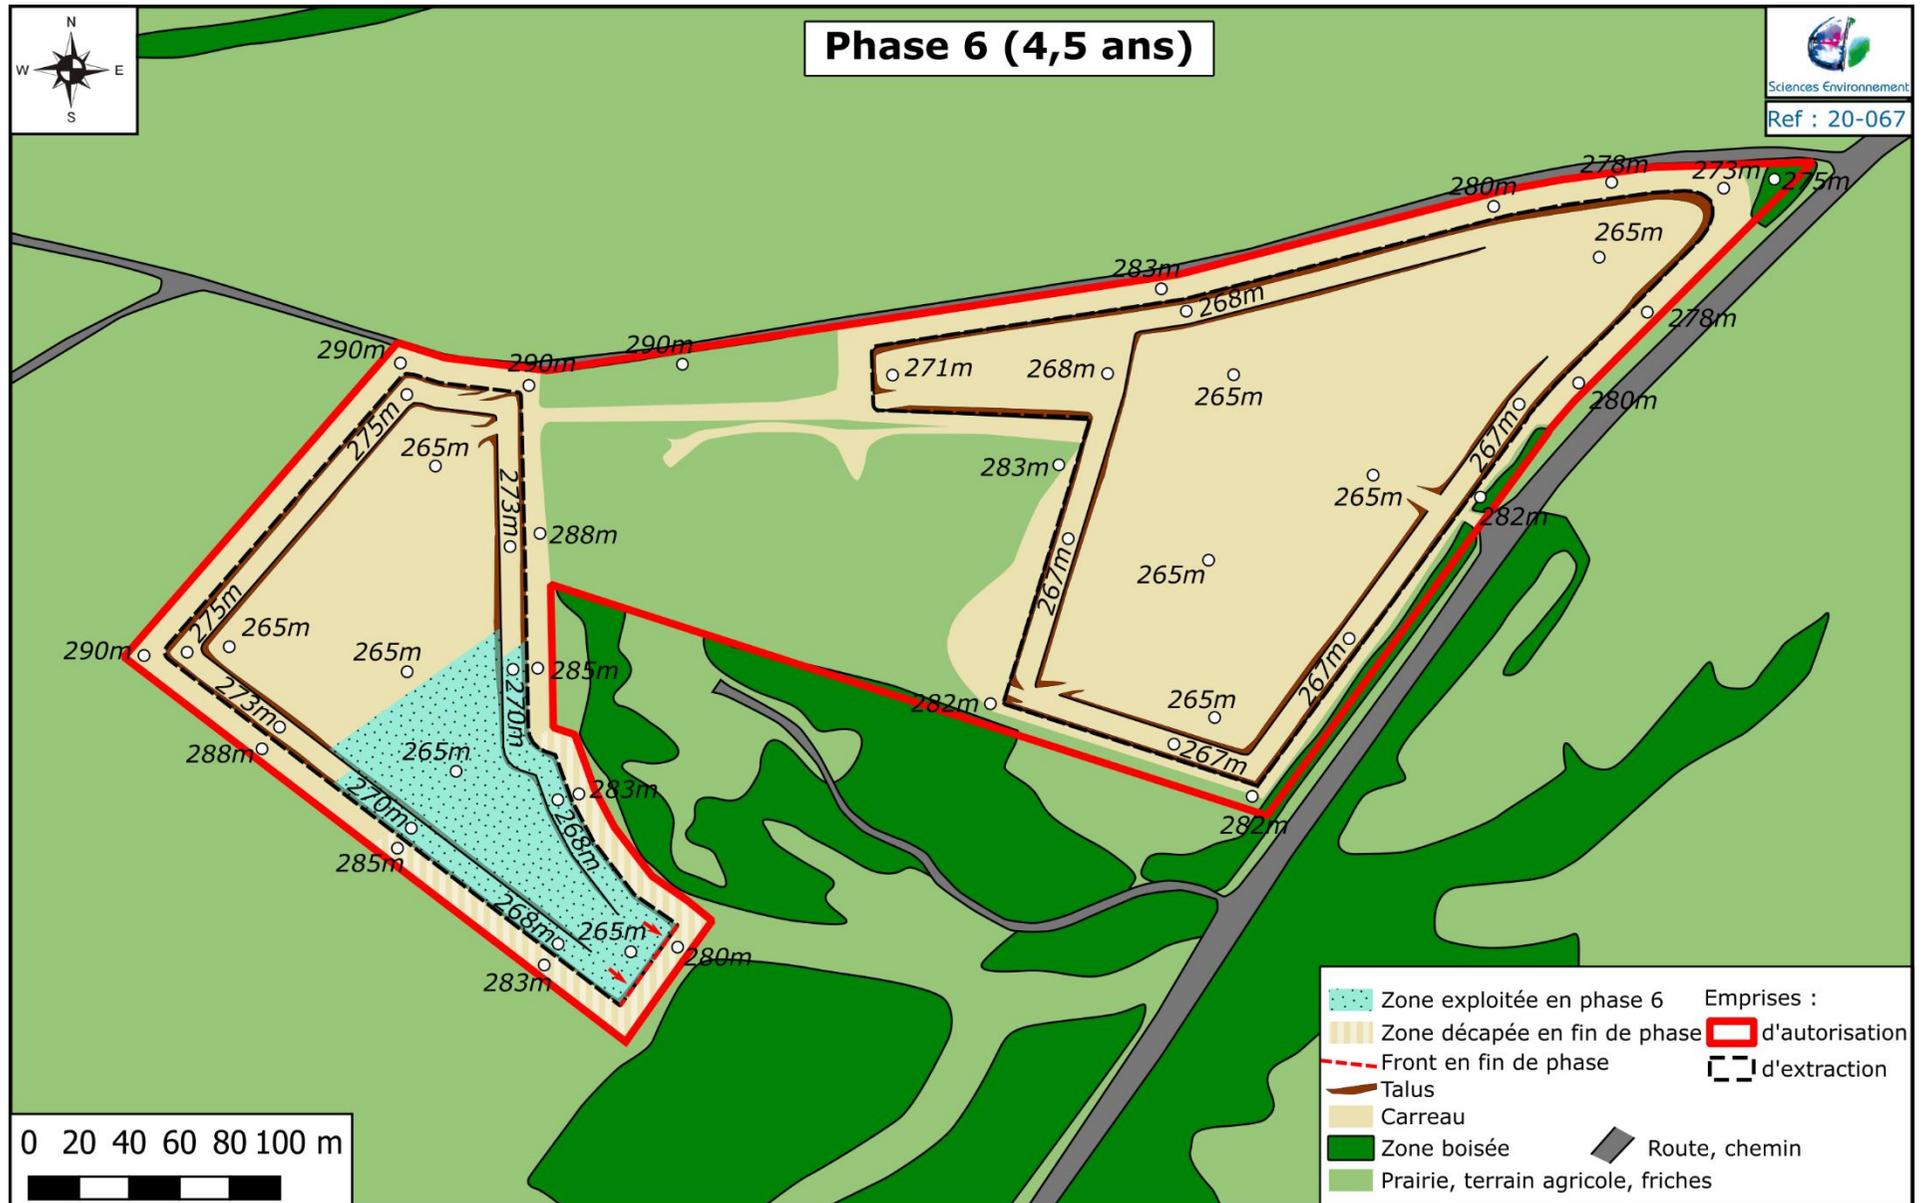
Plan du site en fin de phase 6 (ce plan ne tient pas compte de l'accueil de matériaux inertes ni de la remise en état du site).
